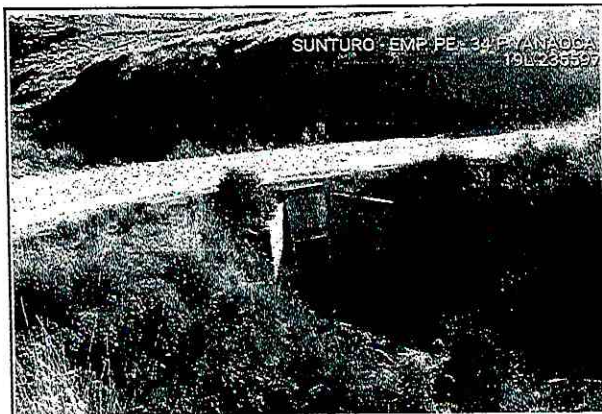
ALCANTARILLA DE CONCRETO 116+250
